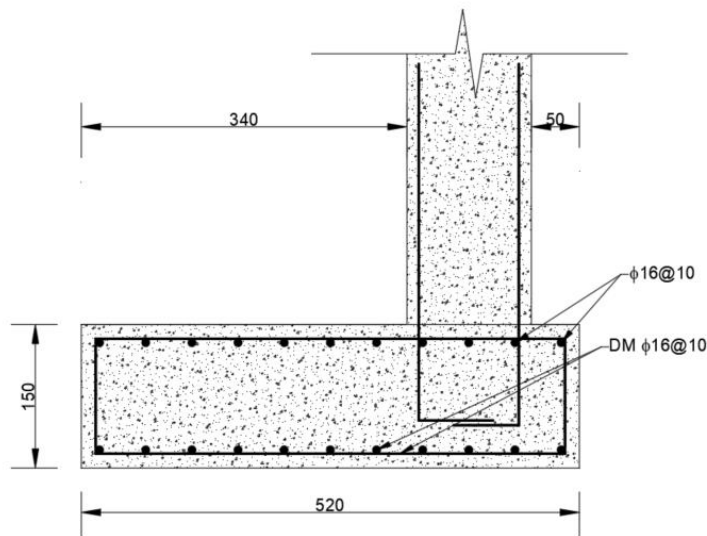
Esquema de la armadura de diseño zapata (dimensiones en cm).
